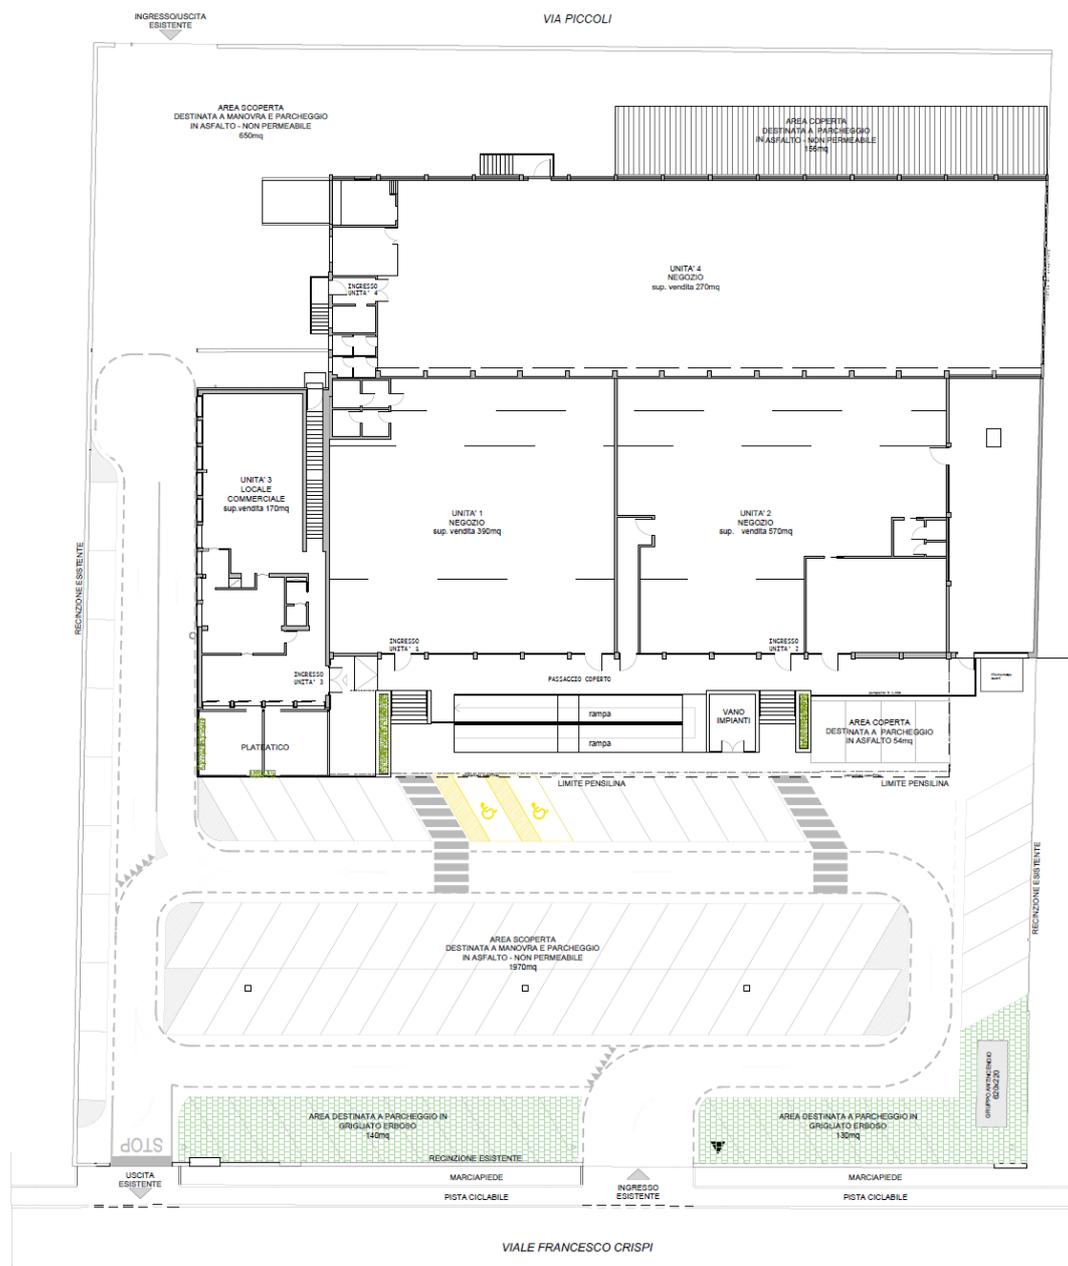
Estratto planimetria attacco a terra – Stato di progetto
